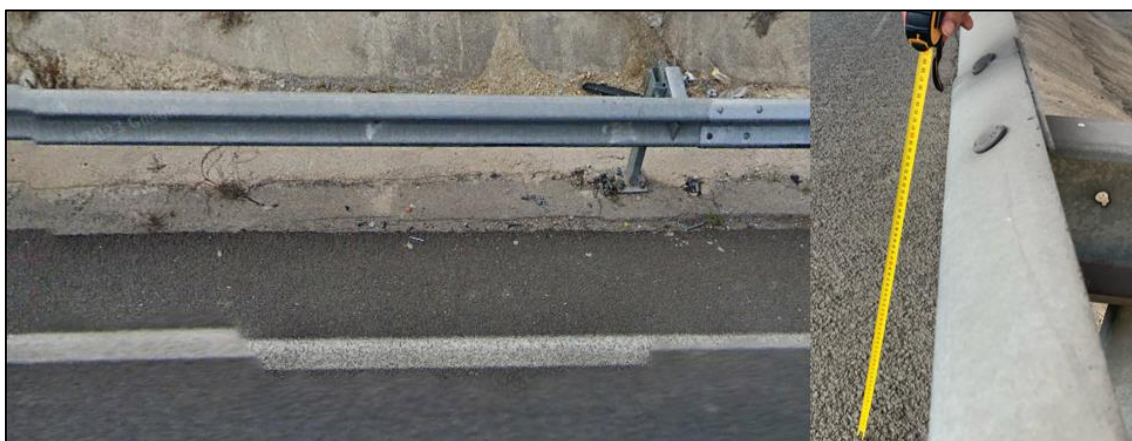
Altura de la barrera metálica insuficiente. PK 2+750 en sentido descendente. (69 cm)
